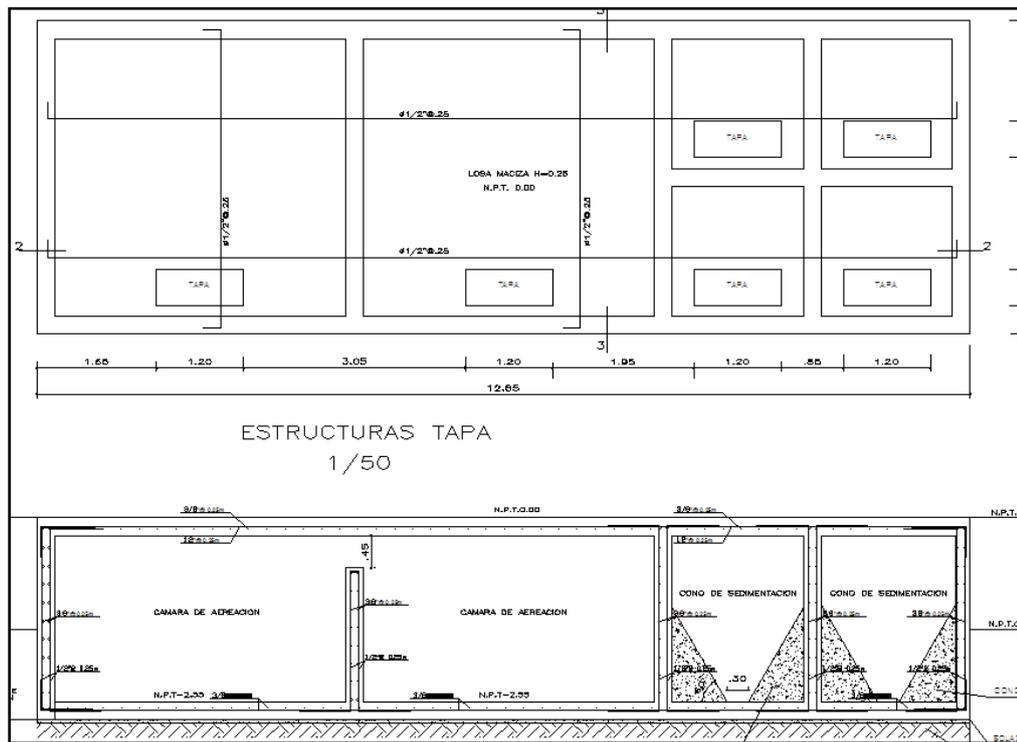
Estructura de Planta de Tratamiento. FUENTE: Elaboración Propia
